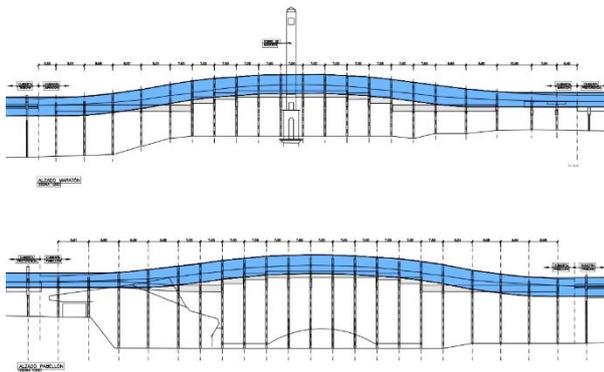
Vistas arquitectónicas en alzado de Maratón y Pabellón. Fuente: elaboración propia.
